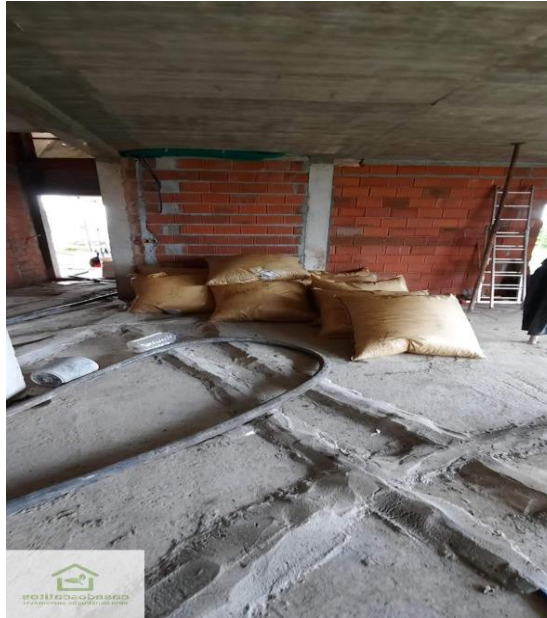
Betão leve utilizado para tapar tubagens [27]
